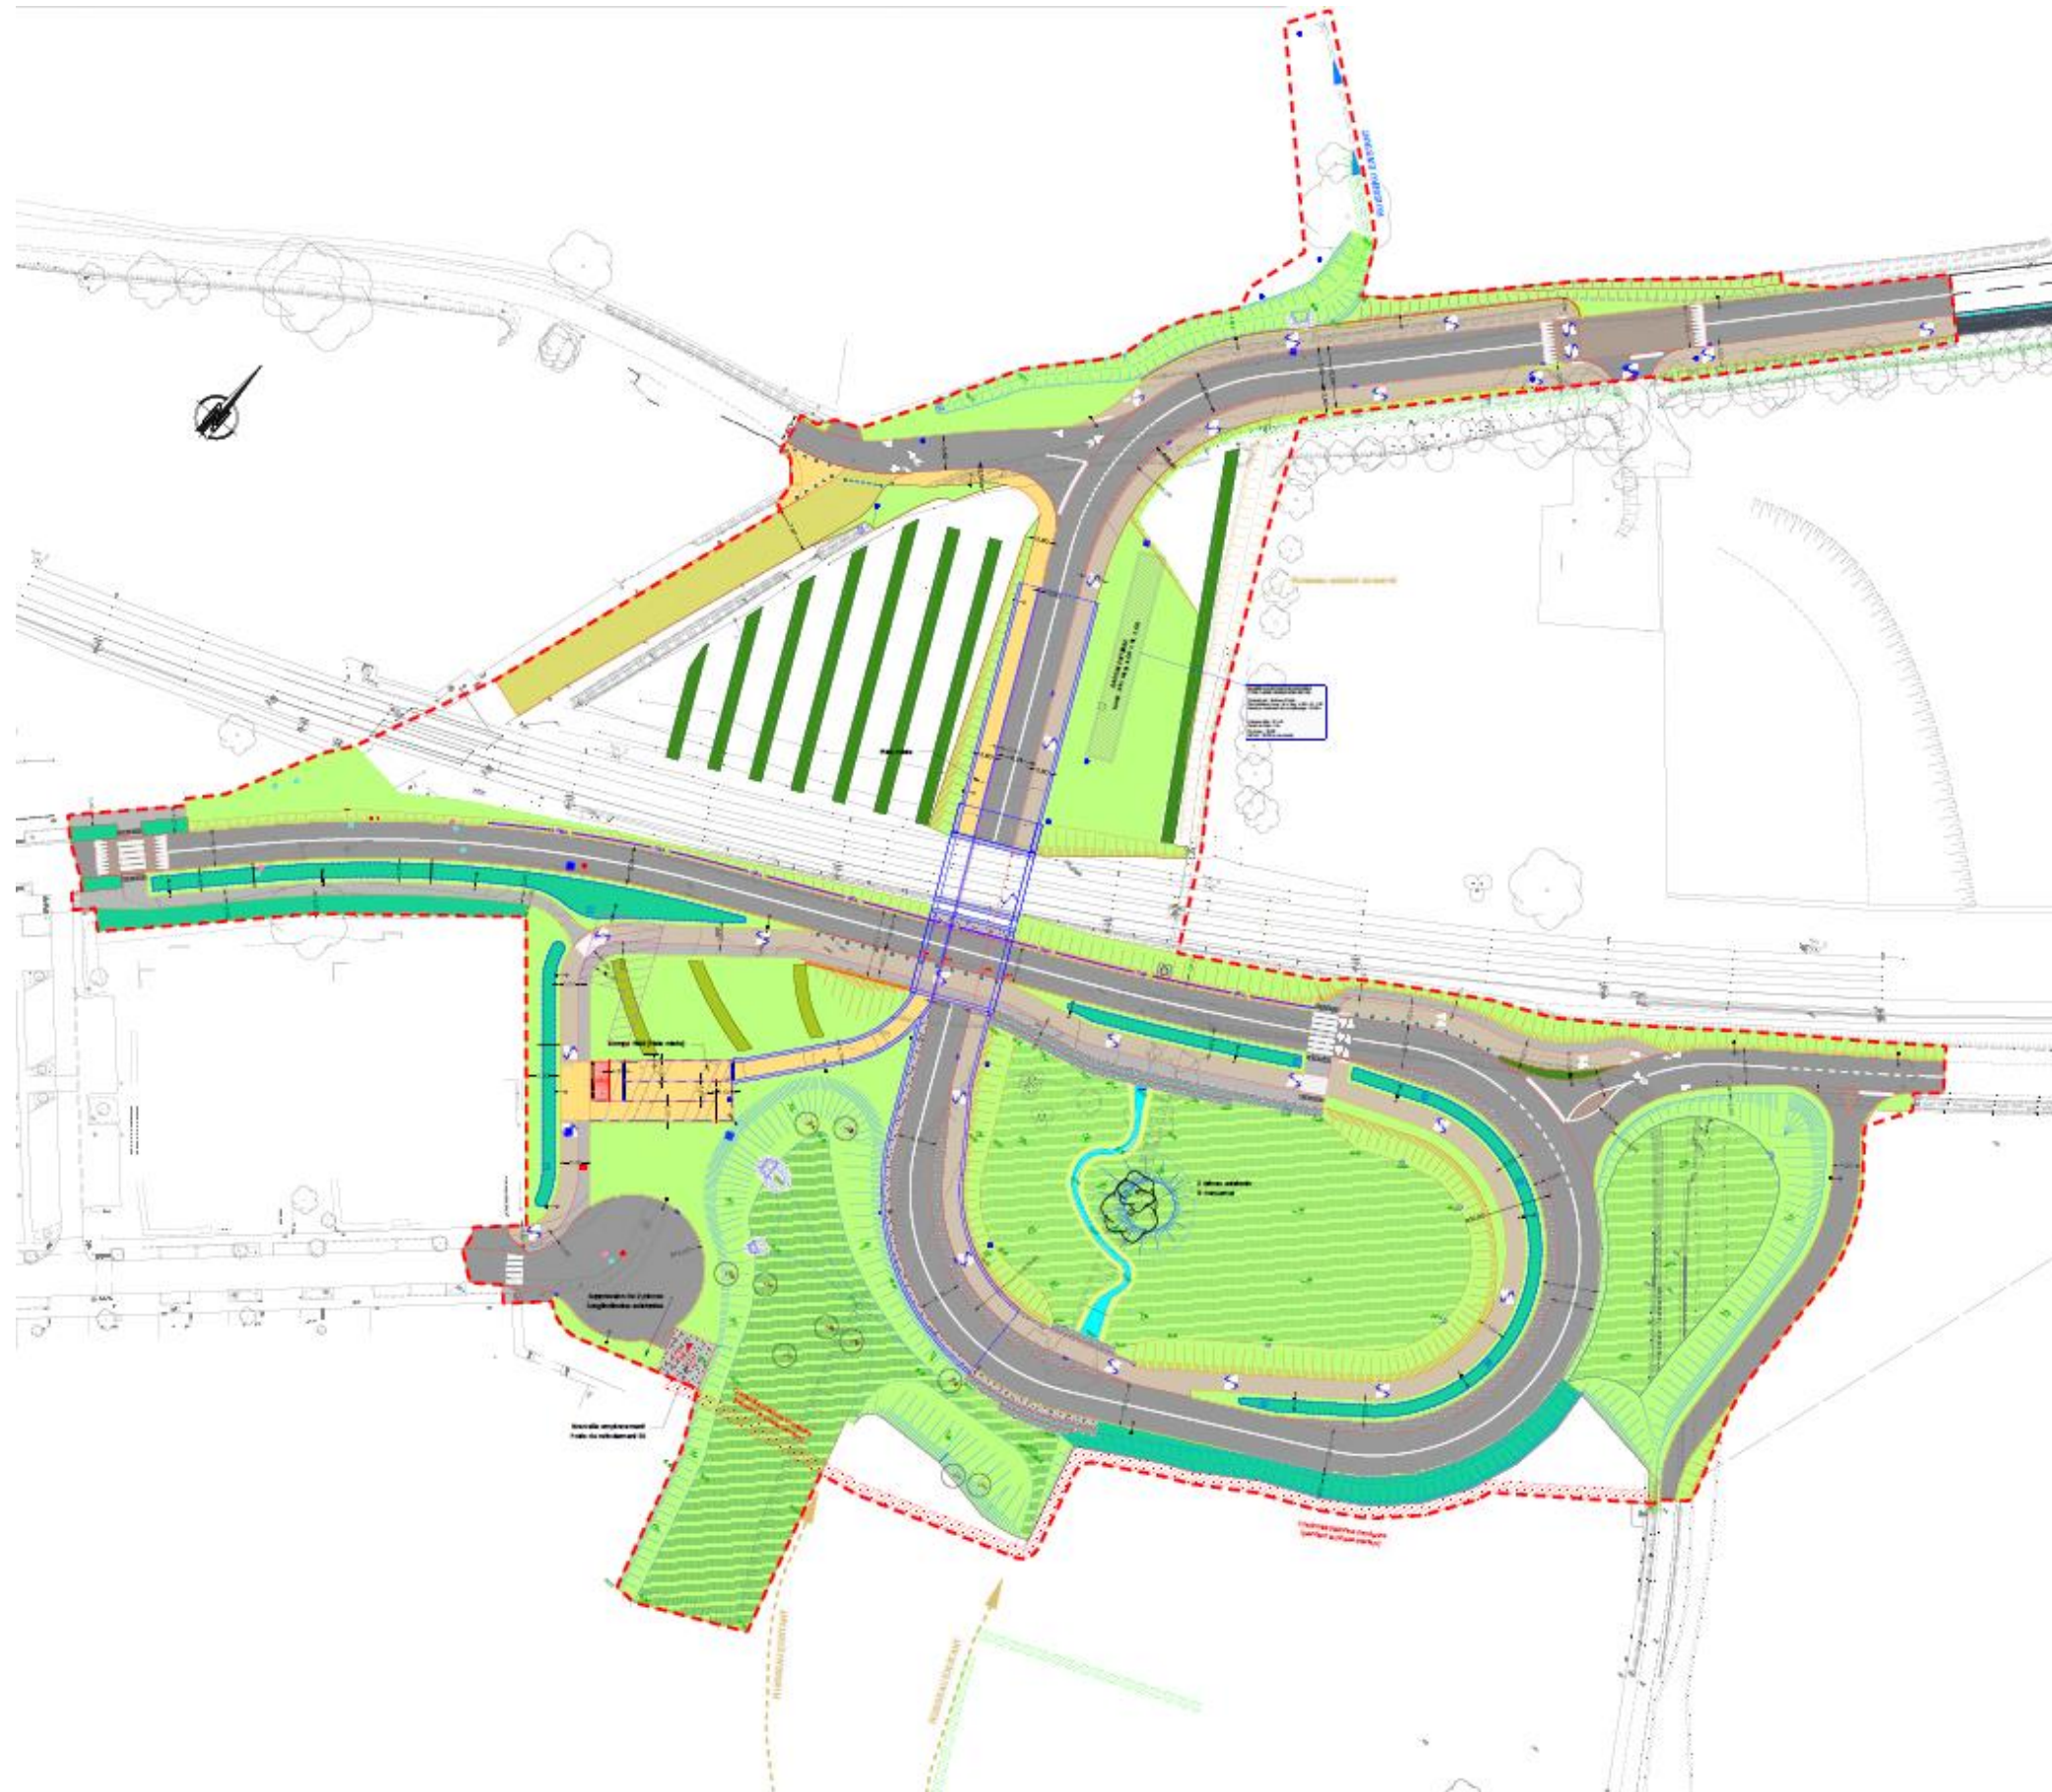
PLAN DE MASSE DU PROJET 1/250EME
